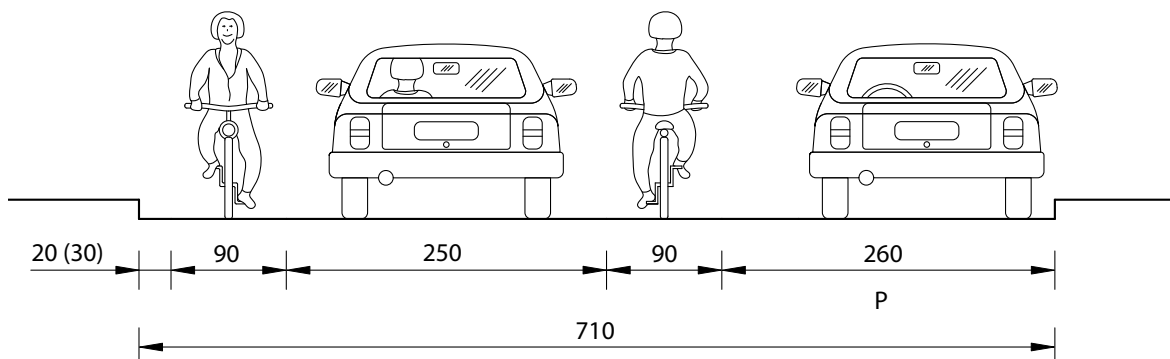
Profil de dimensionnement vélo-auto-auto avec bande de stationnement latéral d'un côté.
